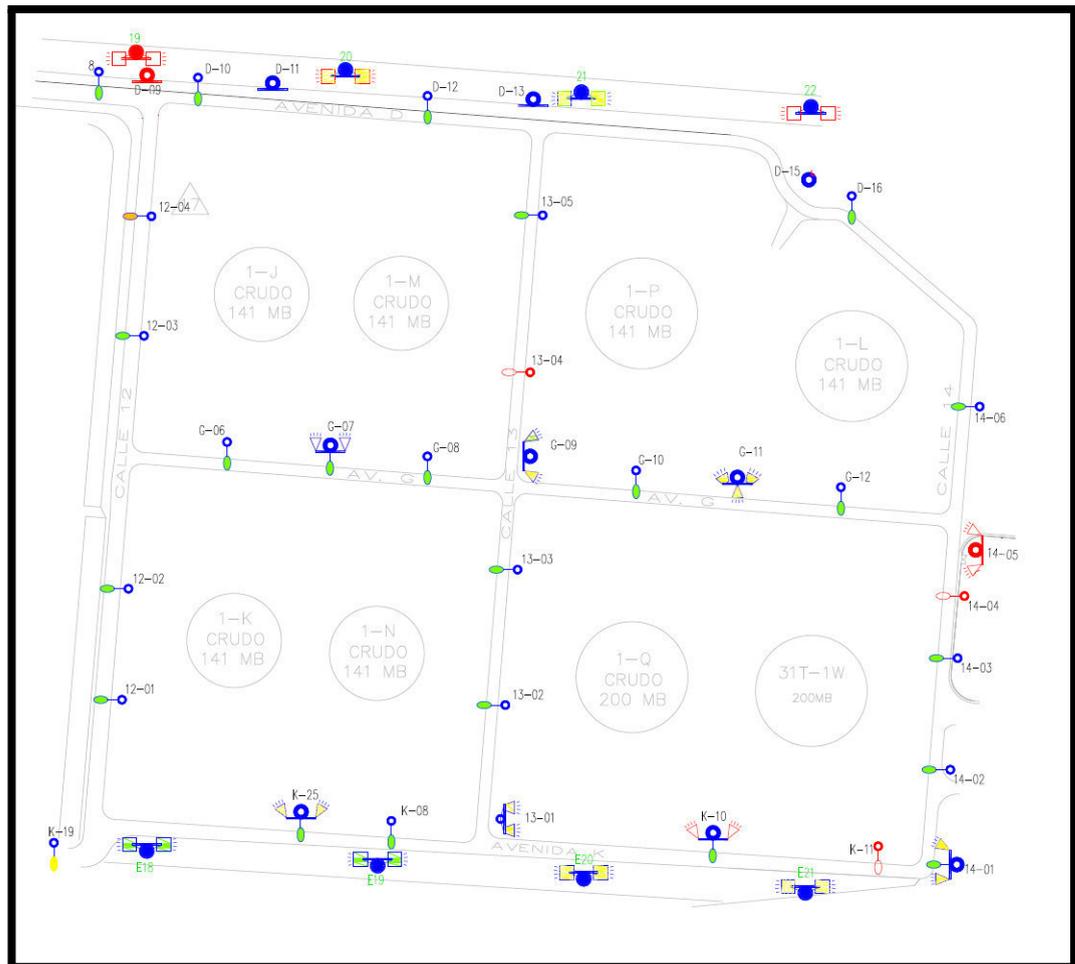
FIGURA SEQ FIGURA_ *ARABIC 5: Plano de distribución Inicial de Iluminación-Vista de Planta
